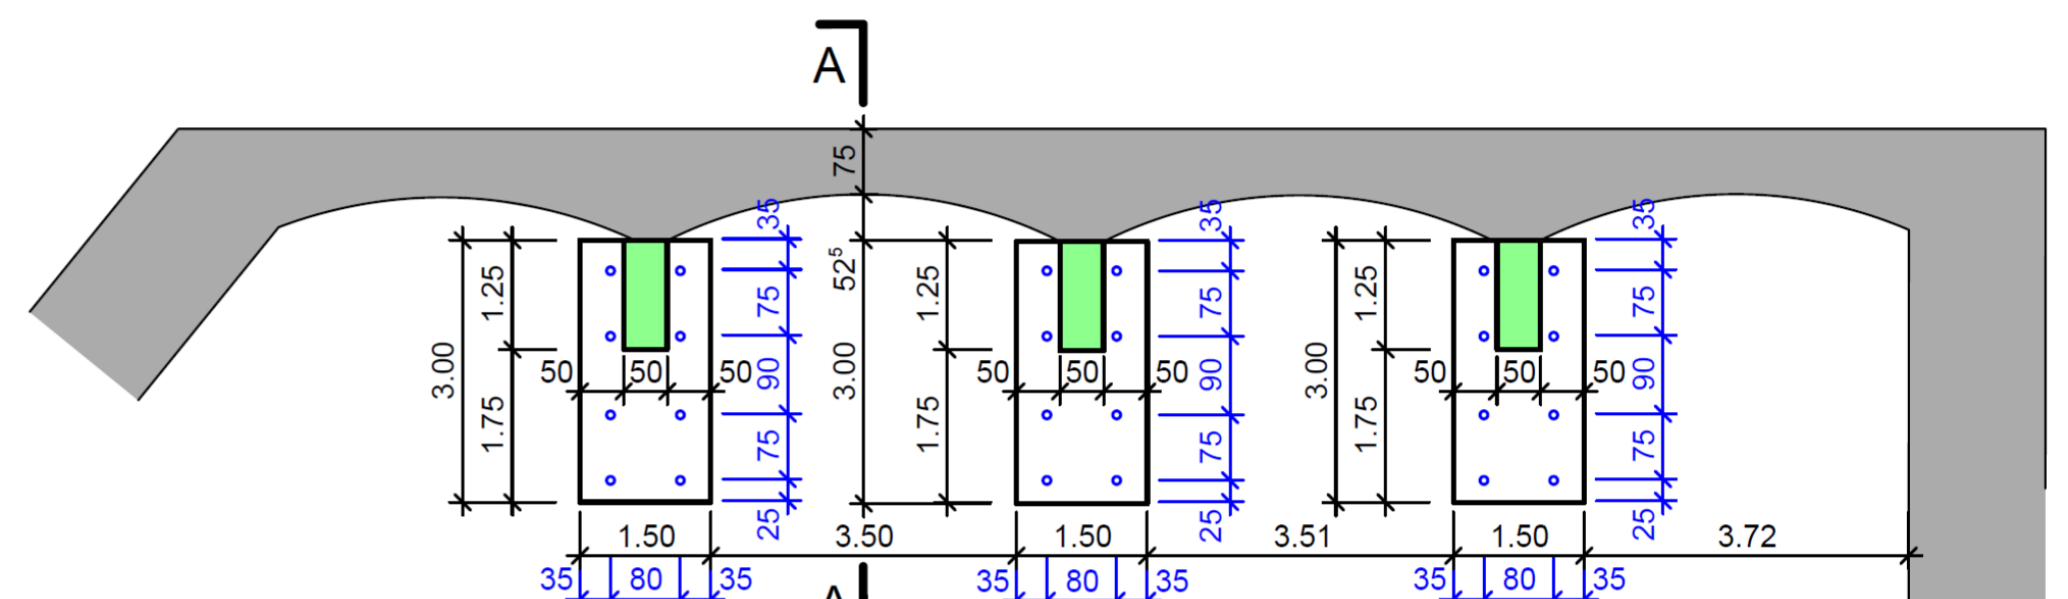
Grundriss Bemessung Stützbaupwerk für Aussenwand Ost (rosa Bereich)
